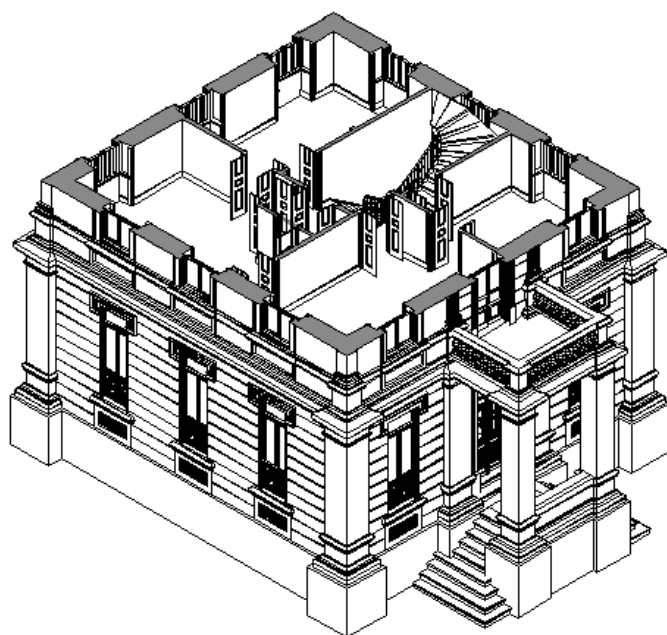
Axonometria do Piso 2 (Geostar, Levantamentos arquitectónicos)
